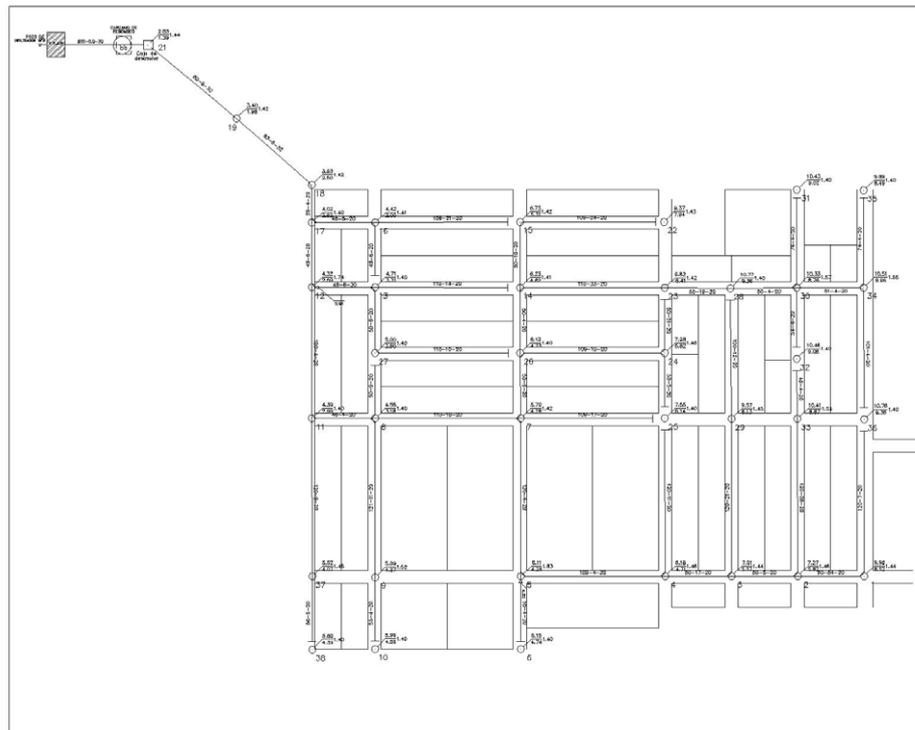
Red de Alcantarillado de Puerto Aventuras
